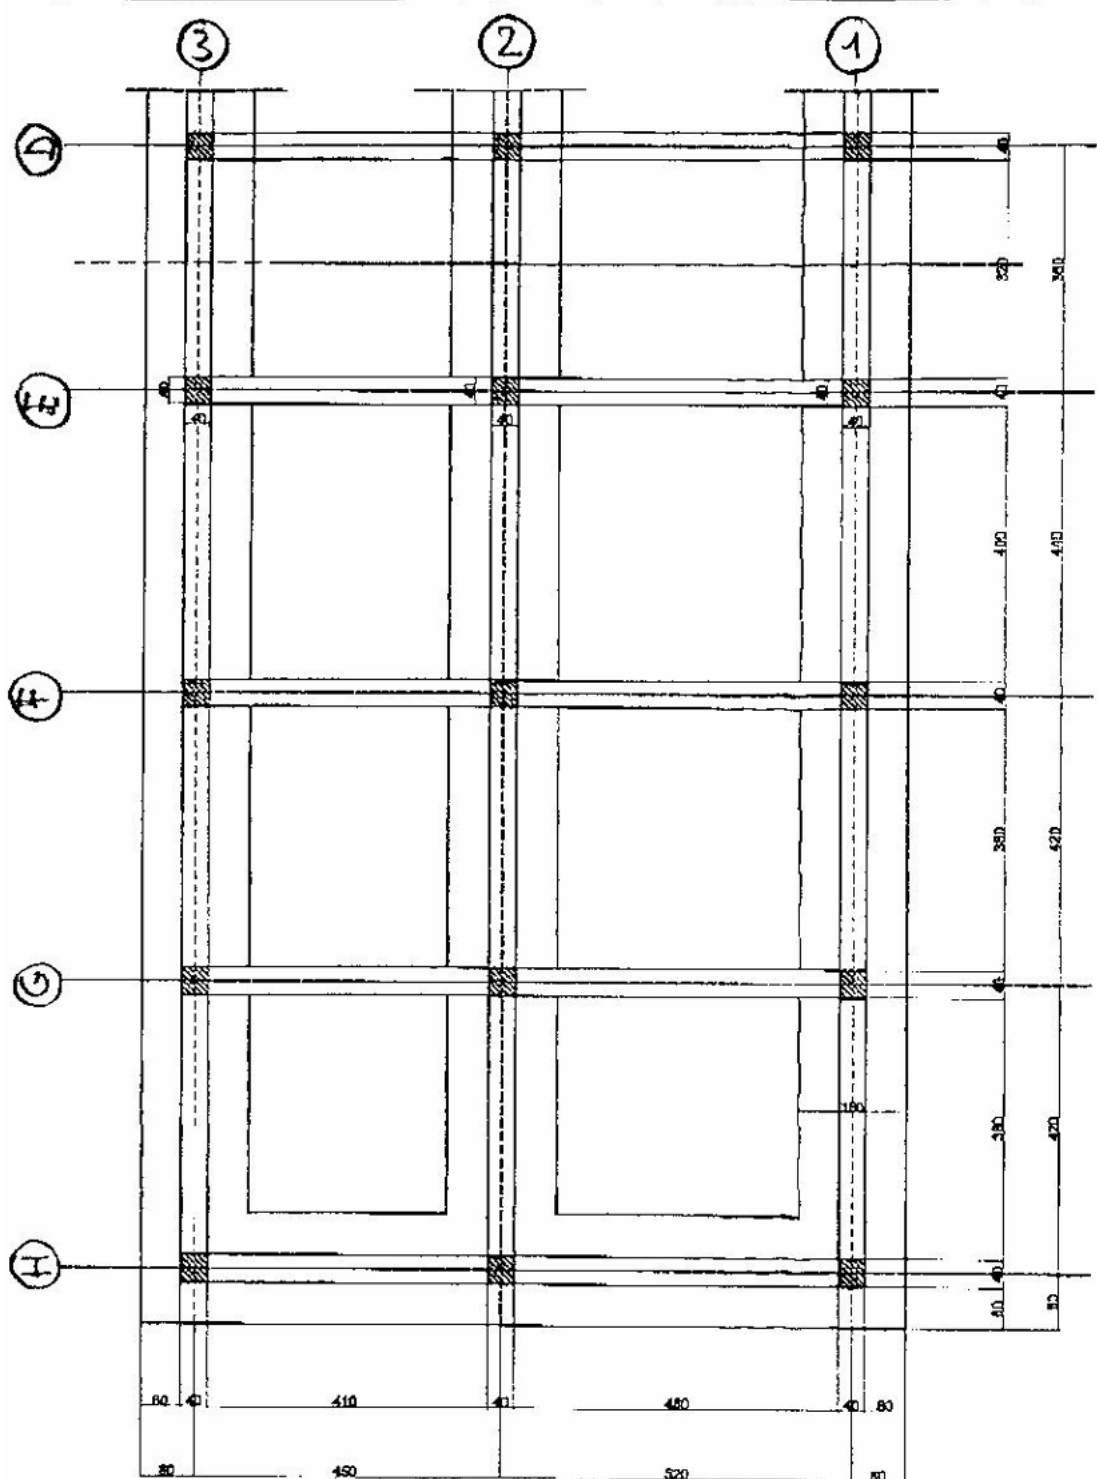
Pianta della fondazione dell'edificio in esempio
